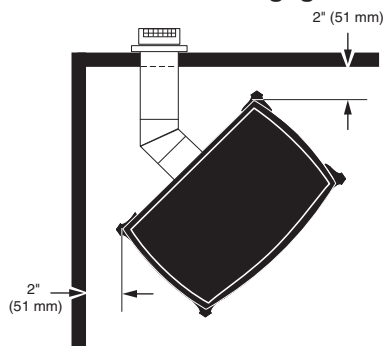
Installation en coin, dégagements minimaux en coin.
